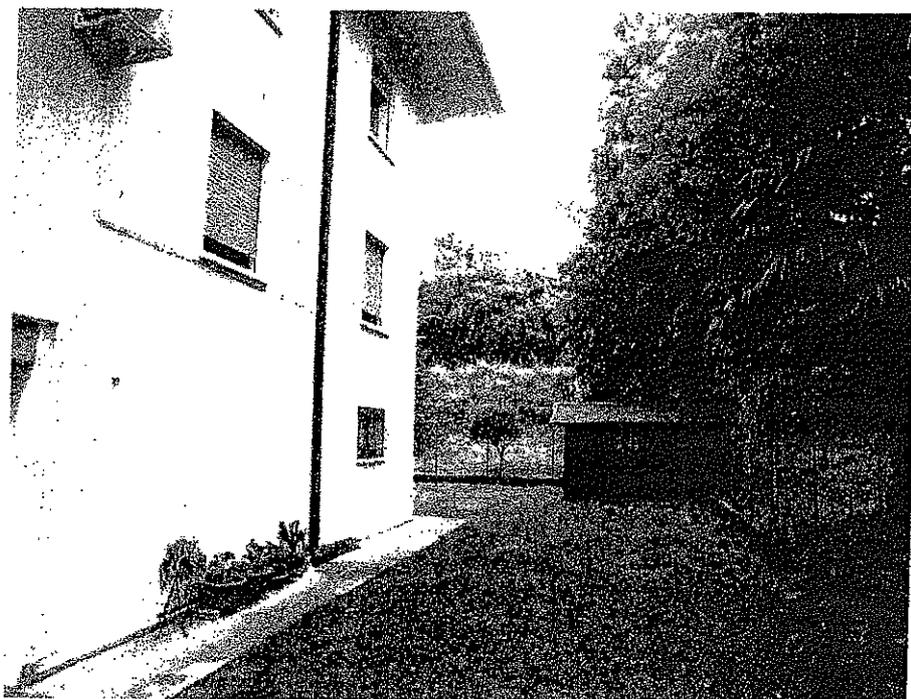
vista prospetto esterno del condominio - casetta di legno-
